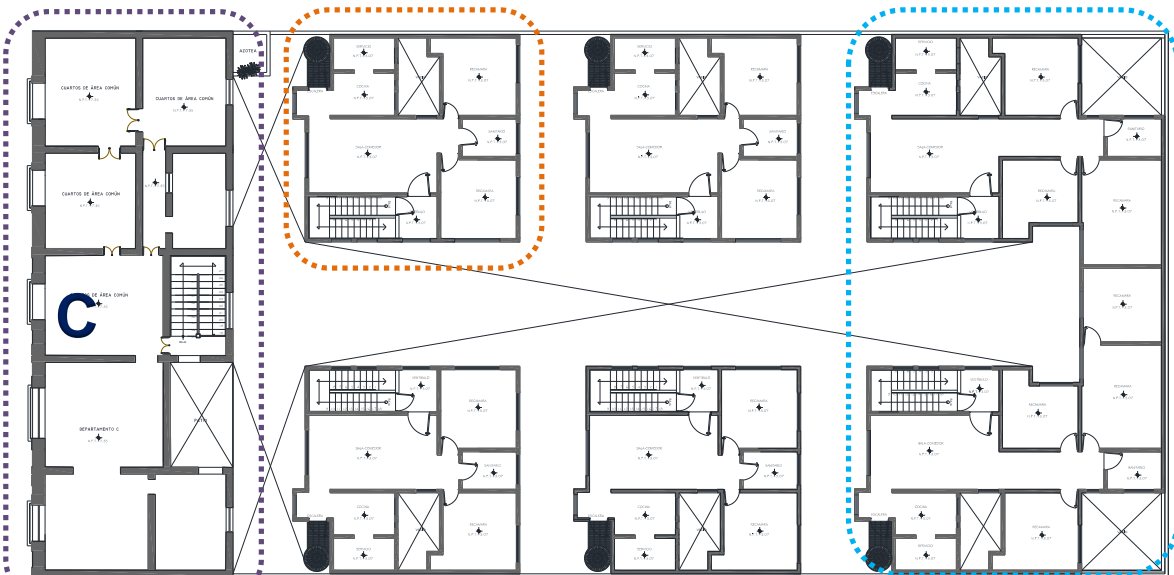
Plantas arquitectónicas en base al levantamiento por FICAPRO, 1991.
